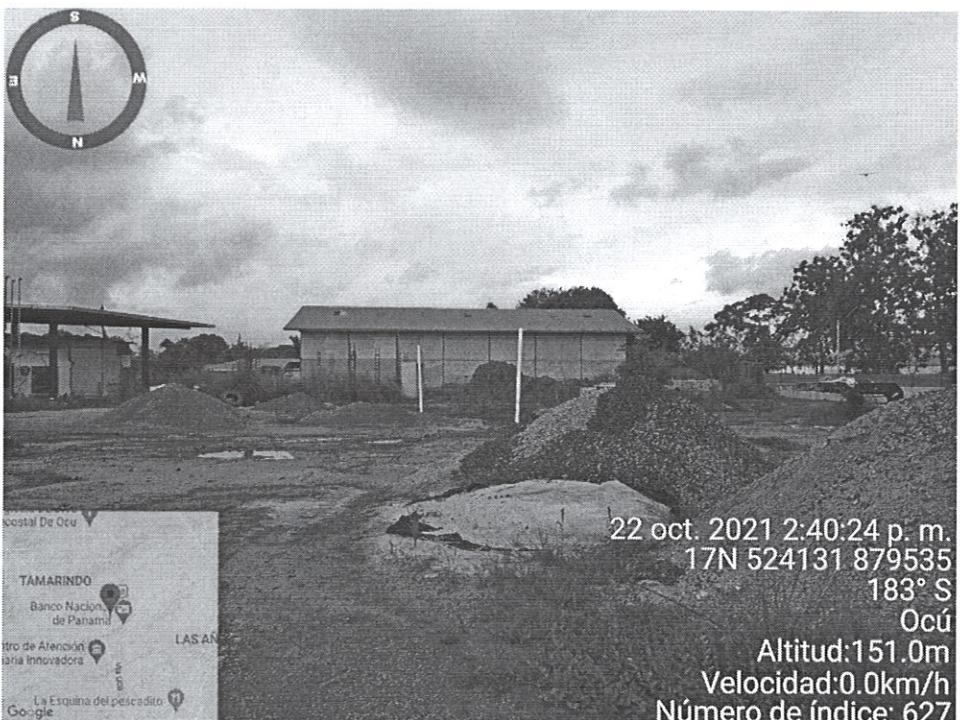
Vista de los materiales de construcción, en el área del proyecto.
